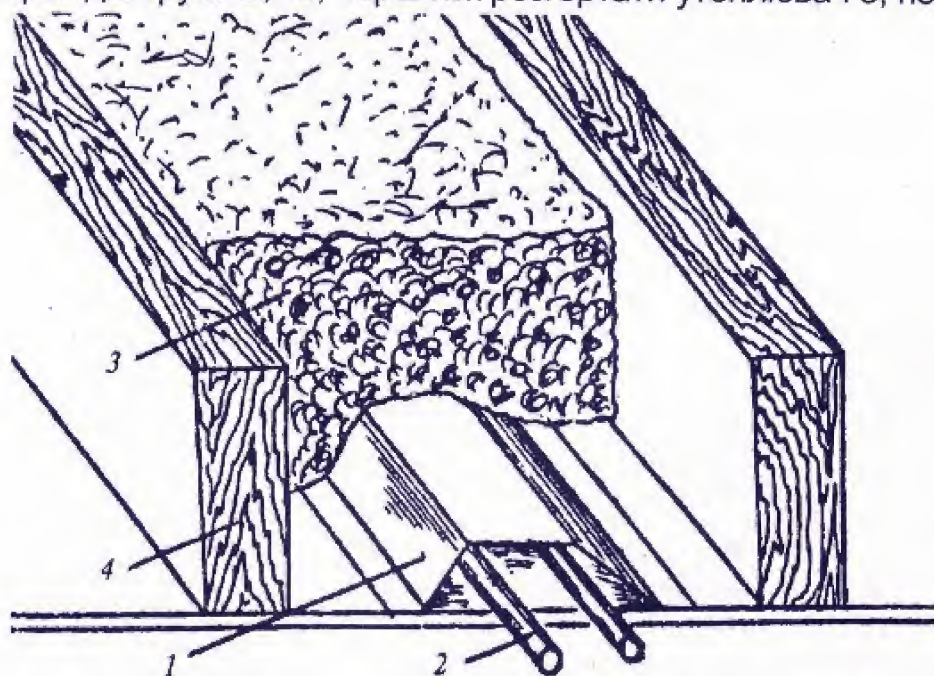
Теплоізоляція водопровідних труб: 1 – брус несучої конструкції; 2 – труба водопровідна; 3 – теплоізоляційний матеріал; 4 – картонна смуга.
